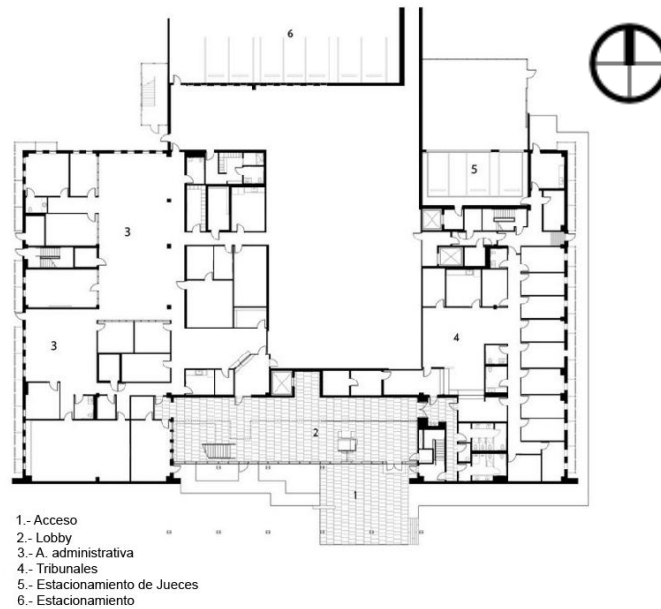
Planta arquitectónica del proyecto Palacio de Justicia John M. Roll. Fuente archdaily.mx. Sin escala.
